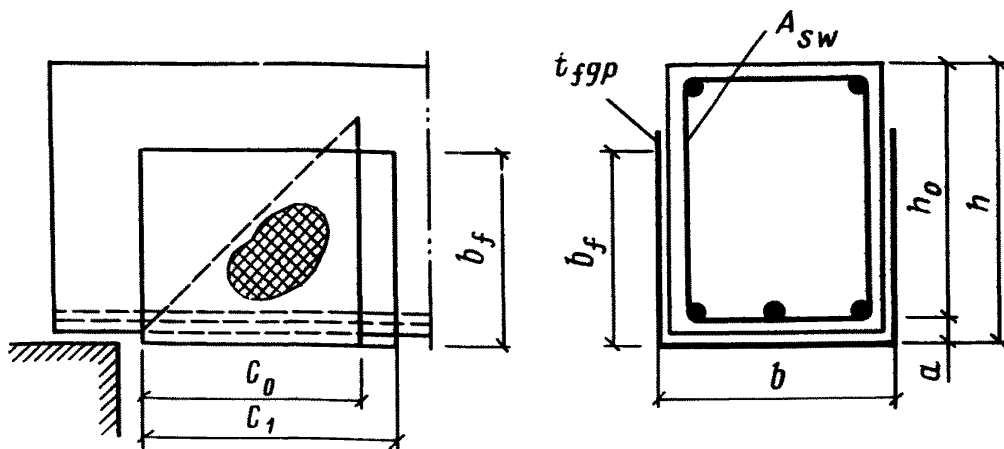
Расчетная схема изгибаемой конструкции, усиленной на воздействие поперечных сил
